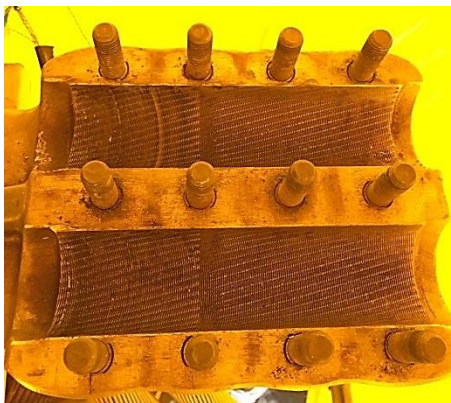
BV 2: Seilklemme (unten) vor Umbau
